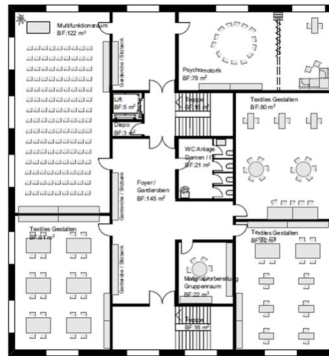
Disposition 03 | Grundriss 2. Obergeschoss
